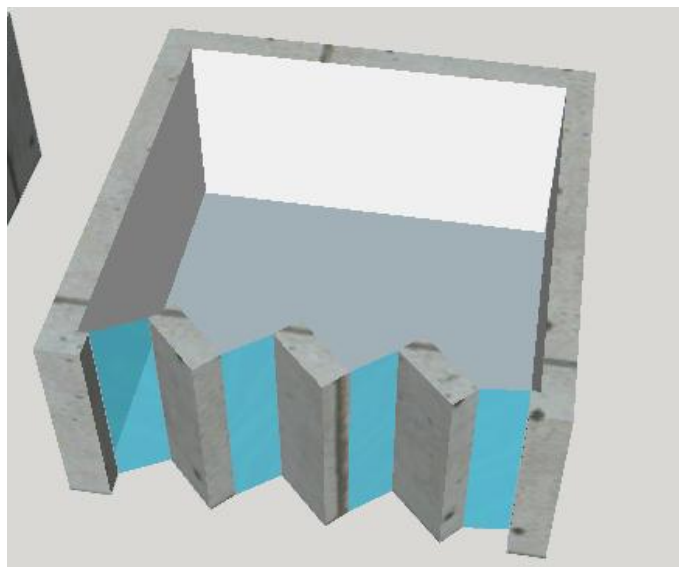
3D illustrant la première proposition de façade. (Auteur)
